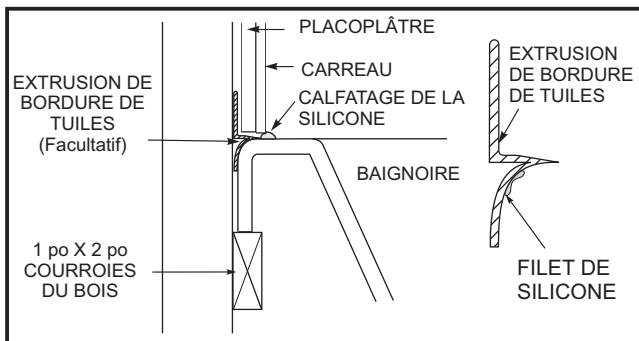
TOMBER-DANS LE BAQUET DANS L'INSTALLATION DE NICHE. LE BOIS SANGLE, EXTRUSIONS DE TUILES ET RECOUVREMENT MURAL.
